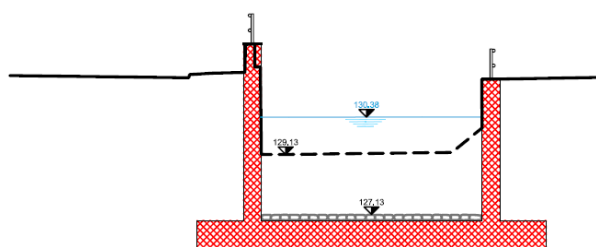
Sezione tipo riprofilatura T. Garza (SDF2006)
